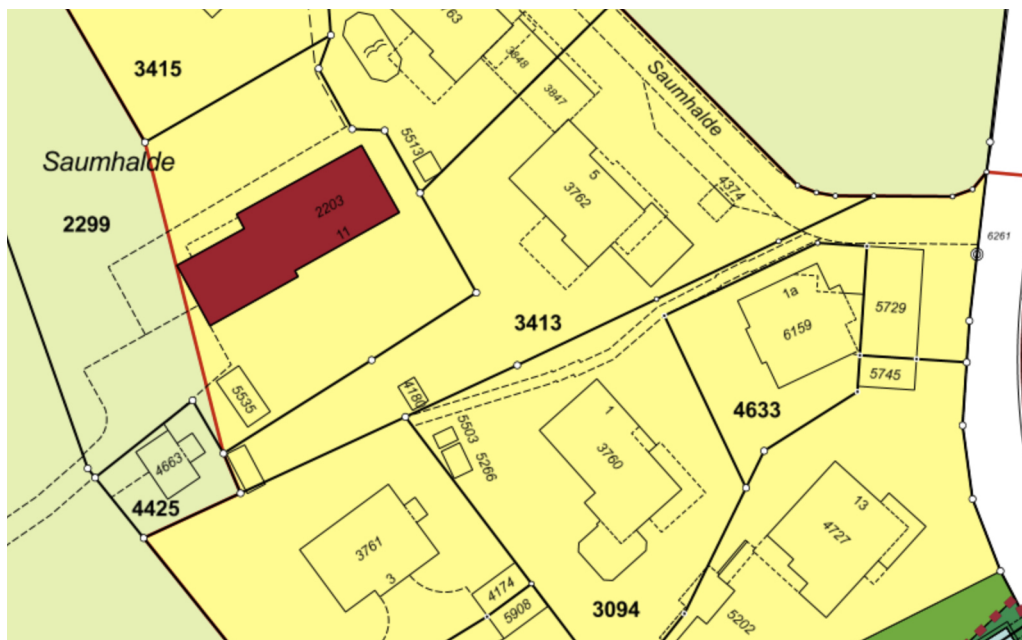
Situation Bestand, Zonenplan mit Saumhalde 11 als geschütztem Kulturobjekt (Plan nordgerichtet)
